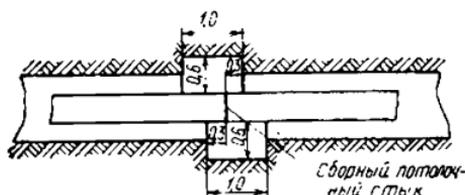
Приямок для сварки неповоротных стыков стальных газопроводов
